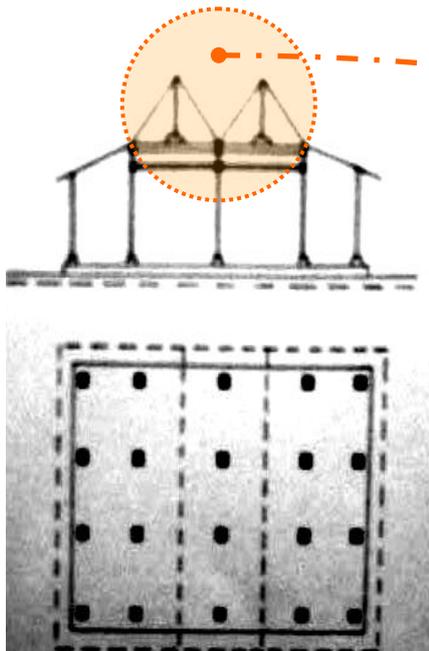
Bangunan Museum Batak Balige, Mengambil Elemen Atap Rumah Batak sebagai Bentuk yang Sudah Dikenal, dalam *Setting* Huta dan Arsitekturnya. Kemiringan dan Jajaran Bangunan Dianggap adalah Elemen Penting yang dapat Mewakili Citra Ruamah dan Kampong (Huta) Batak
